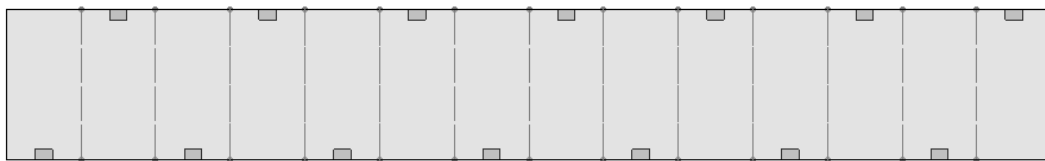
Vista de planta de la distribución 1 de los aires acondicionados.
